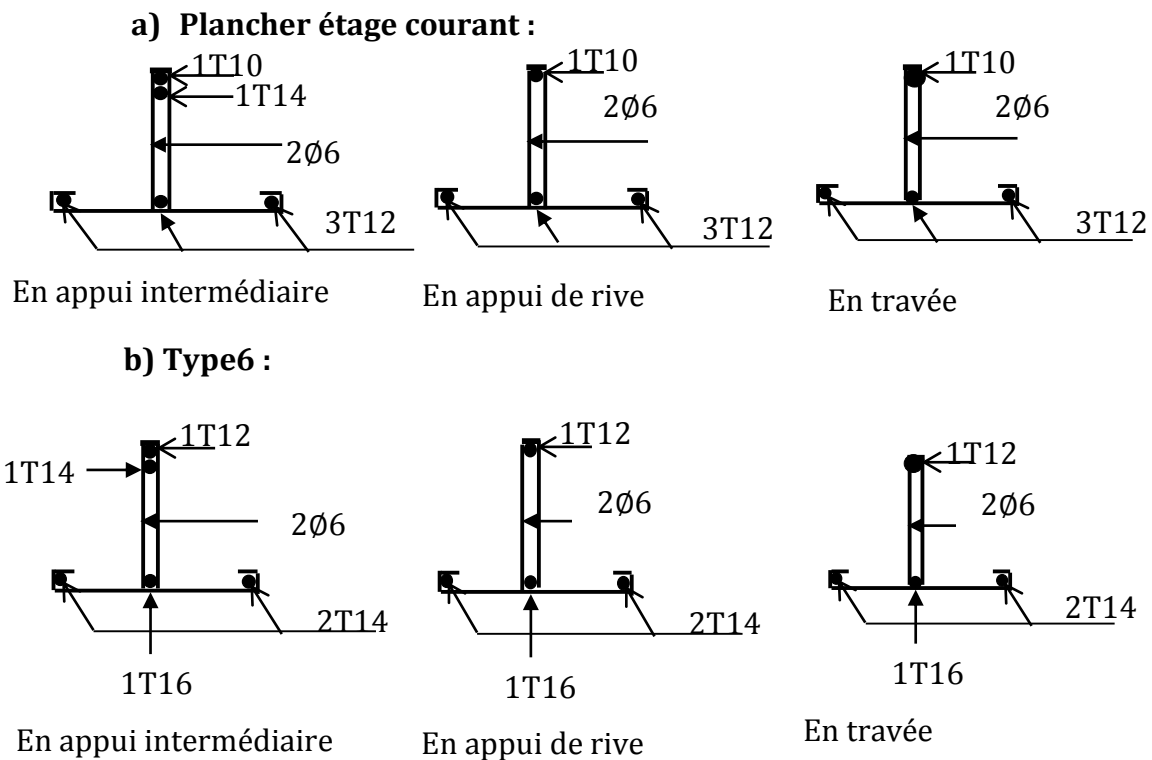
7 : schémas de ferrailage des poutrelles du plancher 16+5
